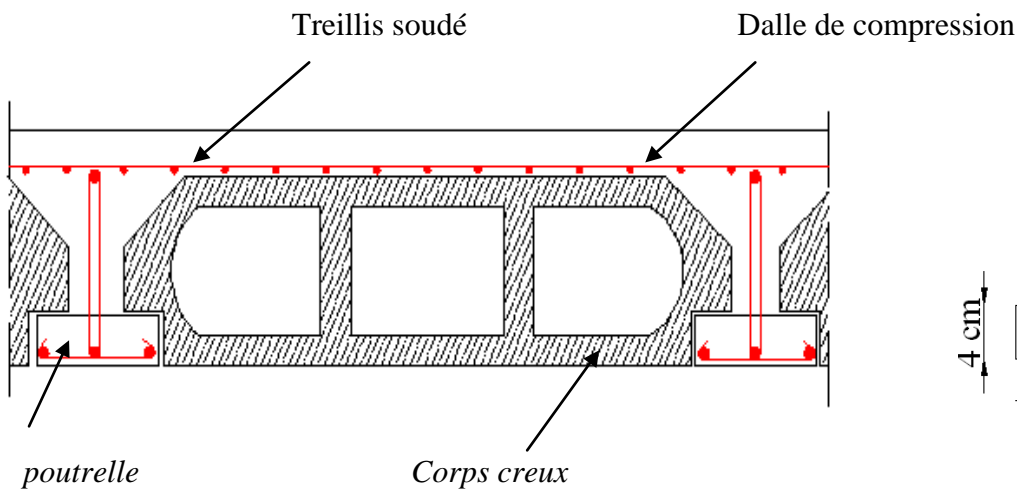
Coupe verticale d'un plancher en corps creux.
